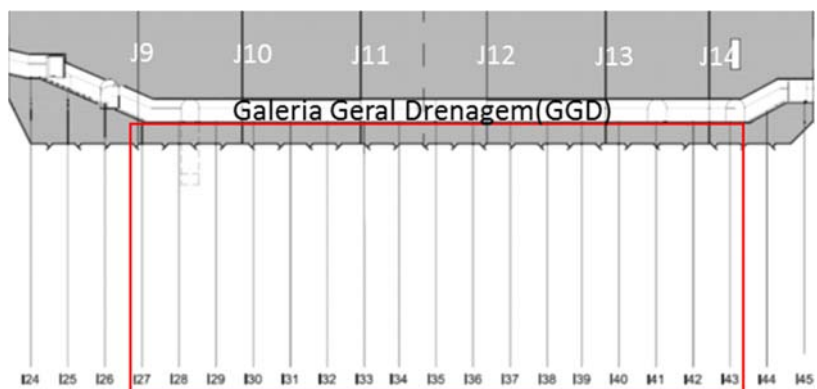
Alçado da cortina de impermeabilização (furação primária-In)¹⁰ no troço do leito rio. Zona estudada. Jn-juntas de betoneagem blocos centrais da Barragem do Feiticeiro. (adaptado de EDP, 2011)
